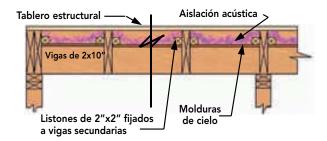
Corte de entrepiso que muestra las molduras fijadas a listones, quedando las vigas a la vista.
